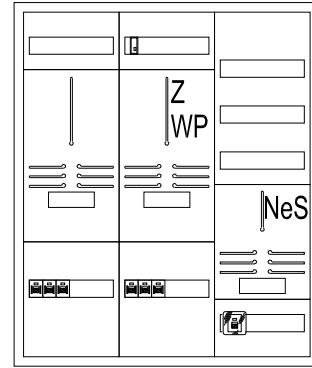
Einkundenanlage mit Wärmepumpe (WP)
